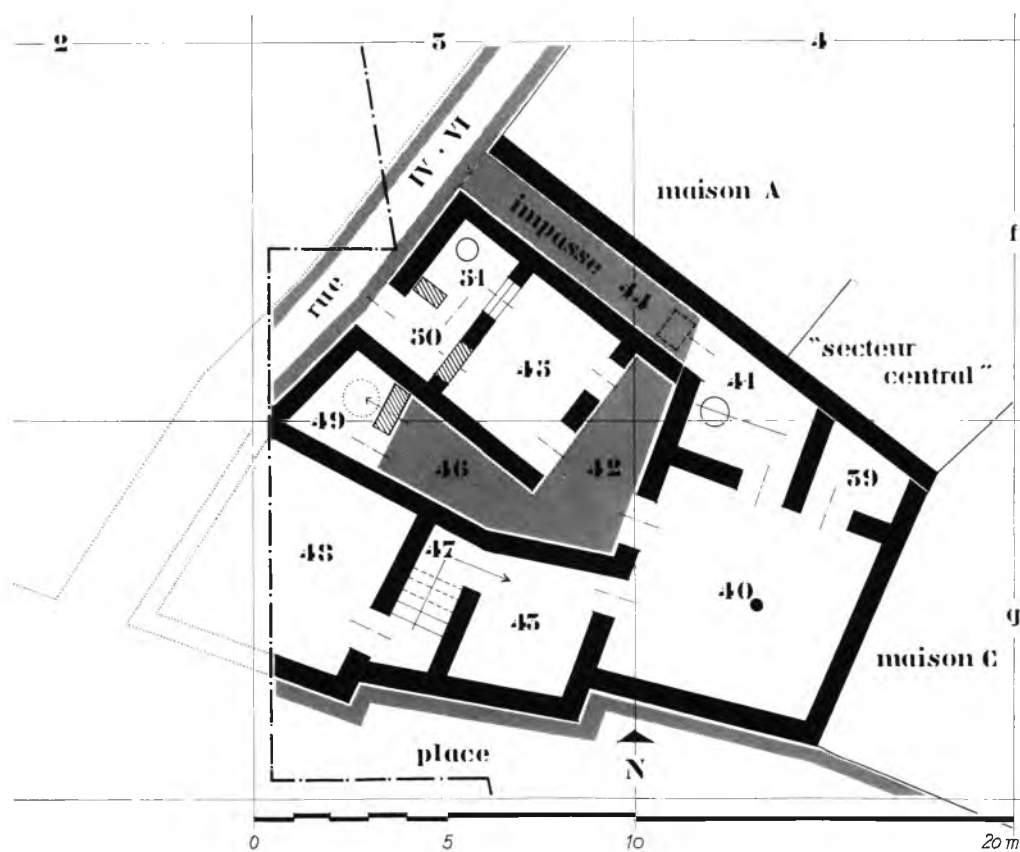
Ilot VI : Maison D, essai de reconstitution du plan.
